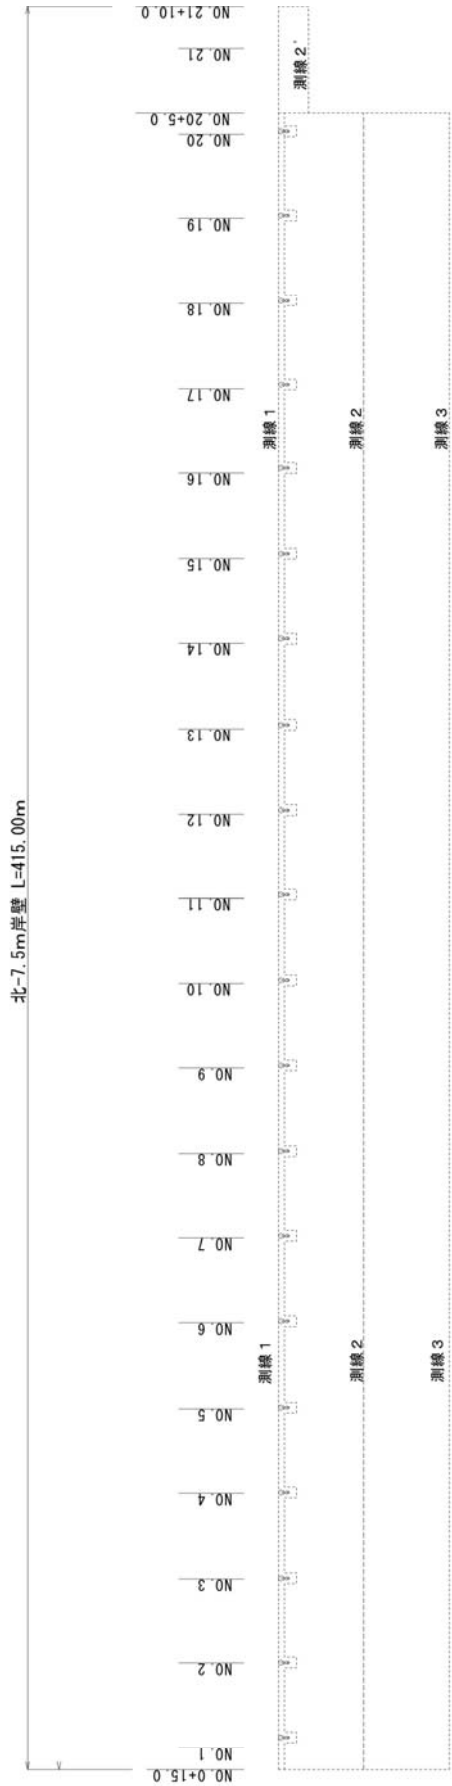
(b) 香椎パークポート地区北-7.5m 岸壁の被災状況平面図②
